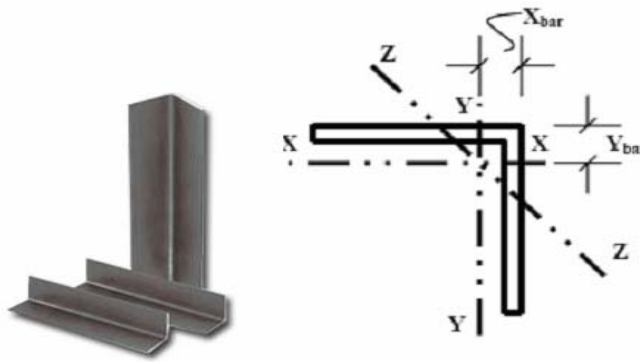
Seção das cantoneiras utilizadas nos banzos das vigas treliçadas (joists) [59]
